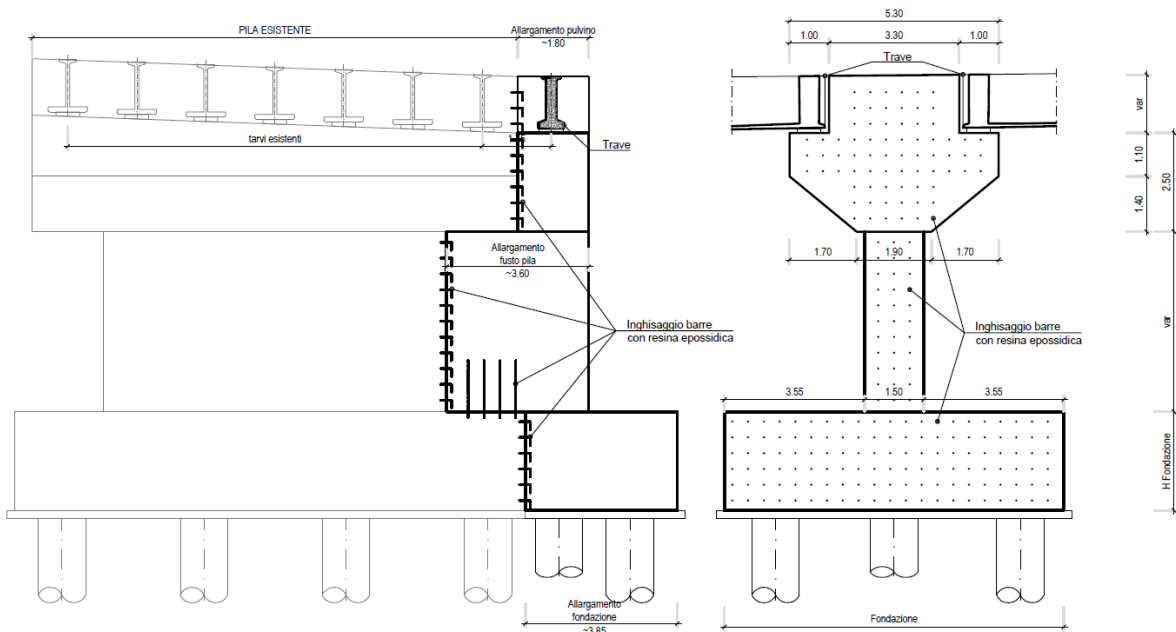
Sezione trasversale pila e pulvino in allargamento
